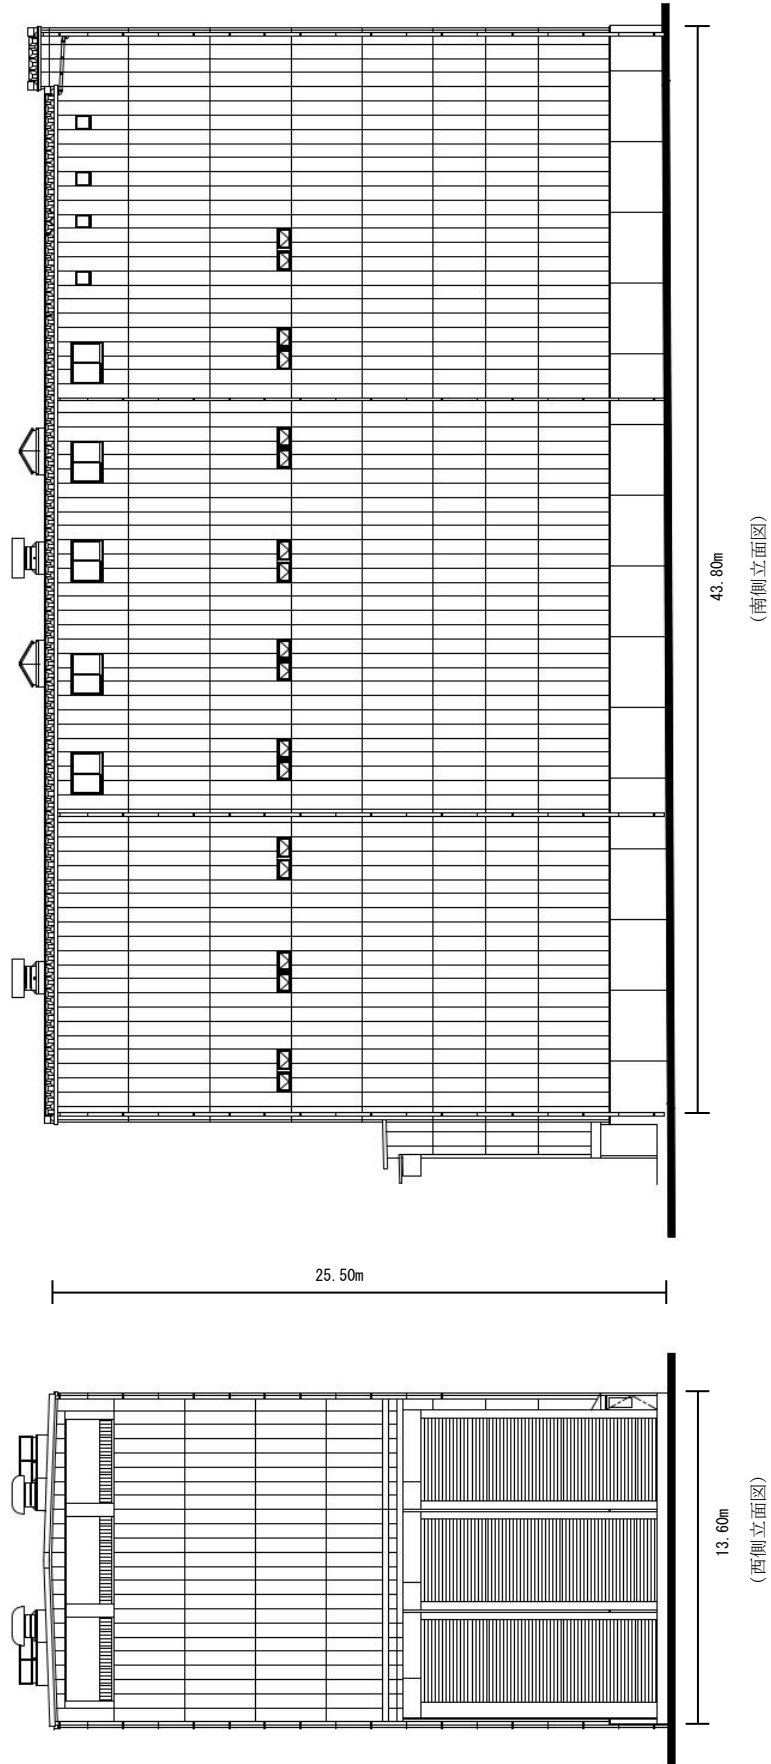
(2) 施設建屋立面図-1 (西・南立面)
